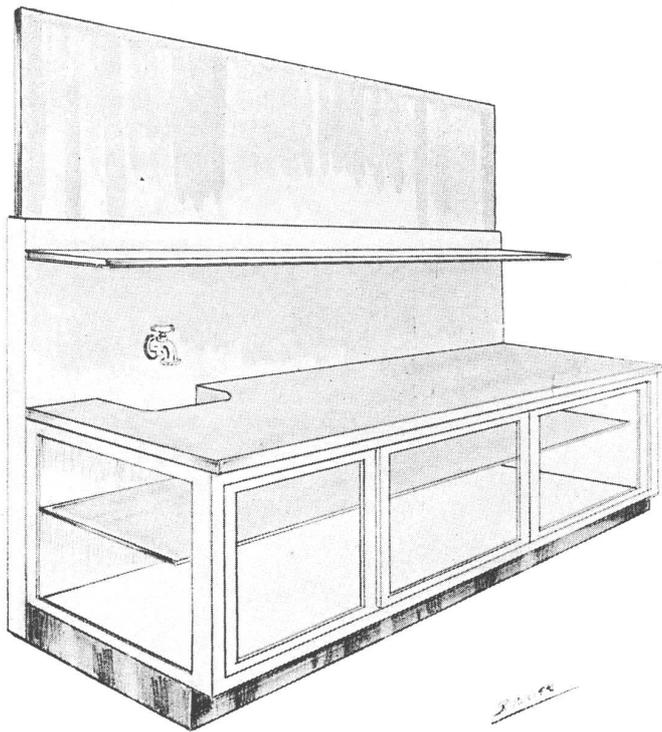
Vitrina baja y accesorios en Sala de Extracción.
